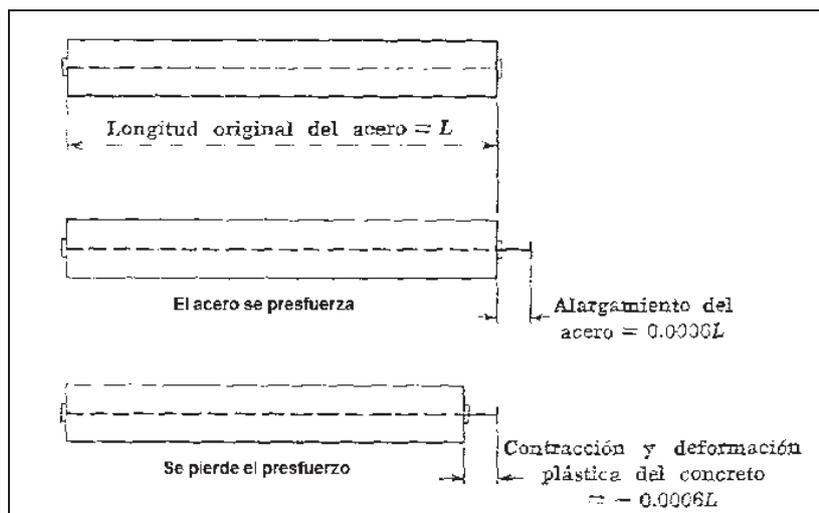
Presfuerzo del concreto con acero estructural ordinario [2].
